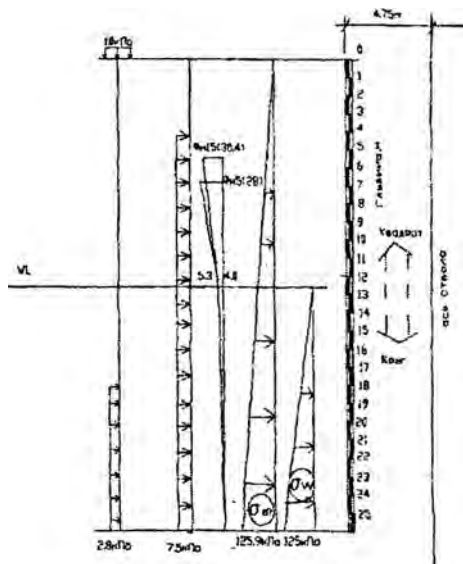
Общая схема нагружения постоянного устья ствола от грунта, фундаментов и воды
